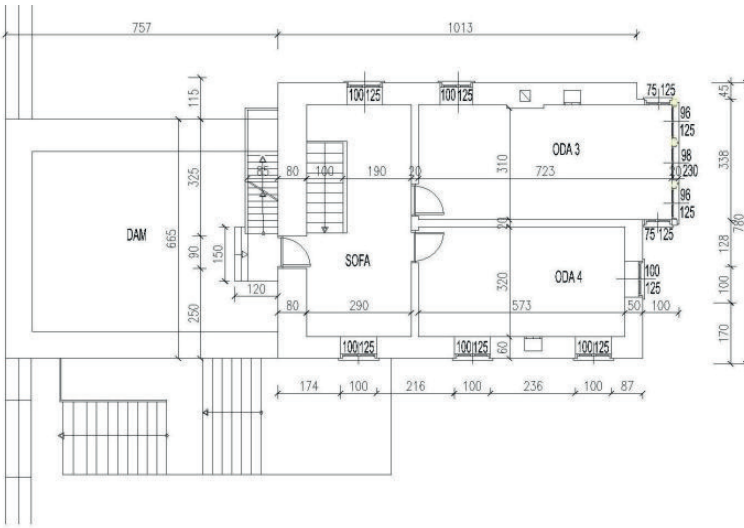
Ara Kat Planı (Özdemir, 2019)
